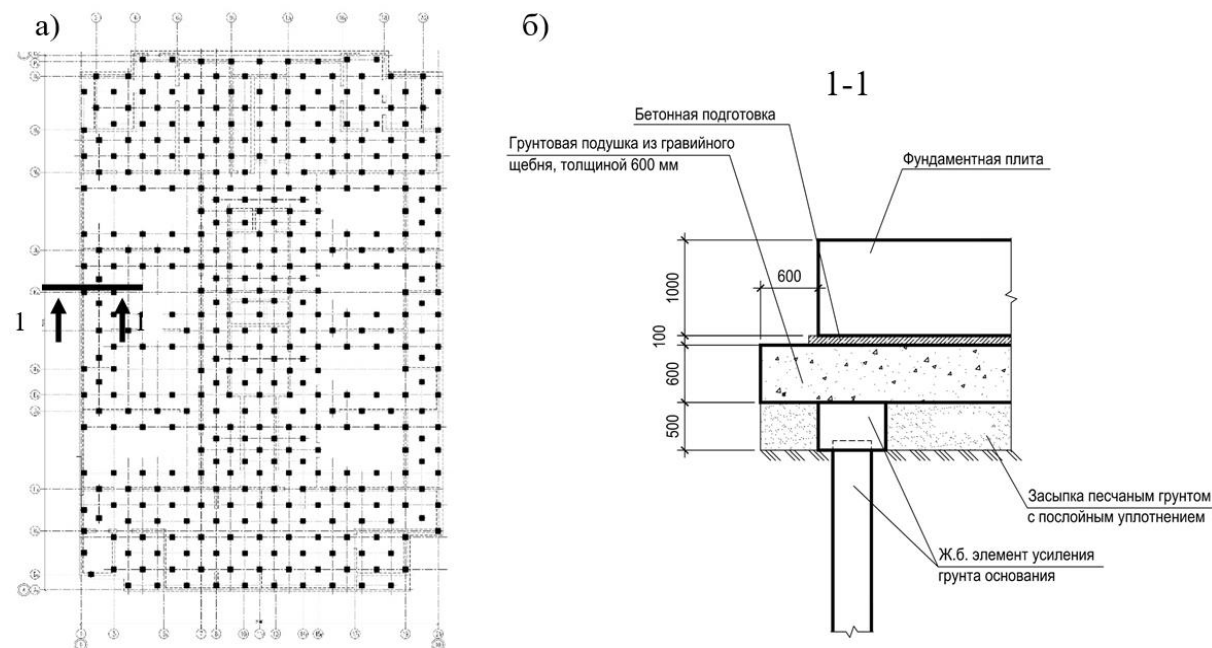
Схема расположения армирующих элементов в пределах фундаментной плиты высотного здания (а) и принципиальное техническое решение фундаментов жилого комплекса (б)
